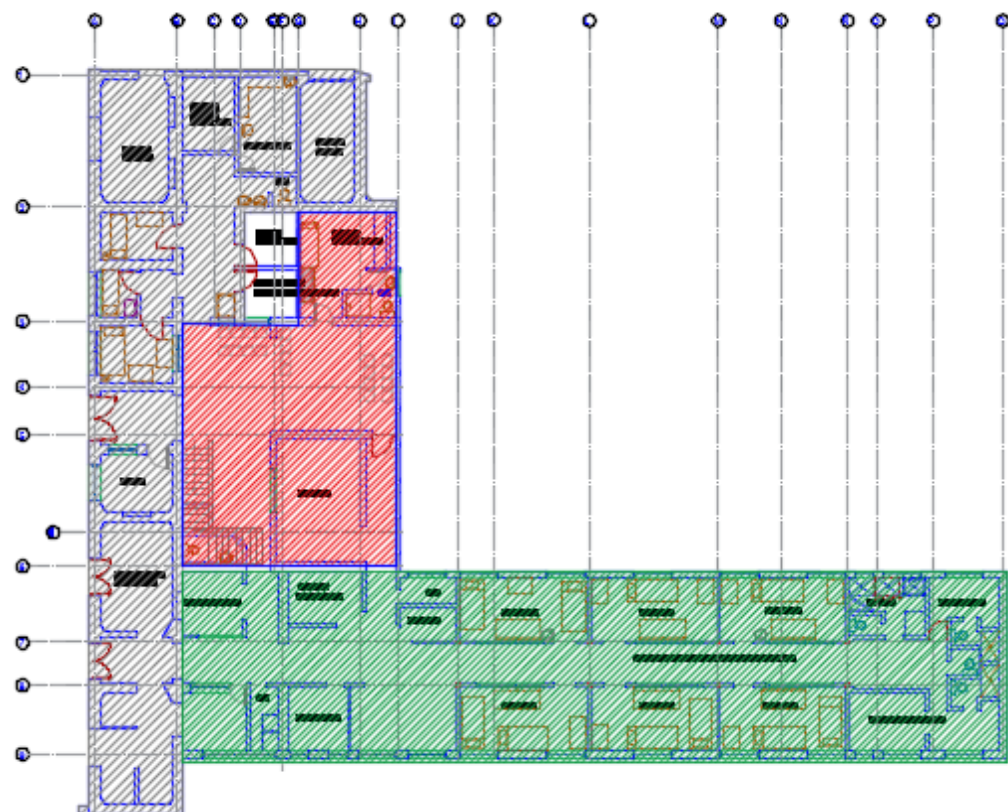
Zona A y Zona B de la estructura (Color rojo y verde correspondientemente). Fuente: Autor
